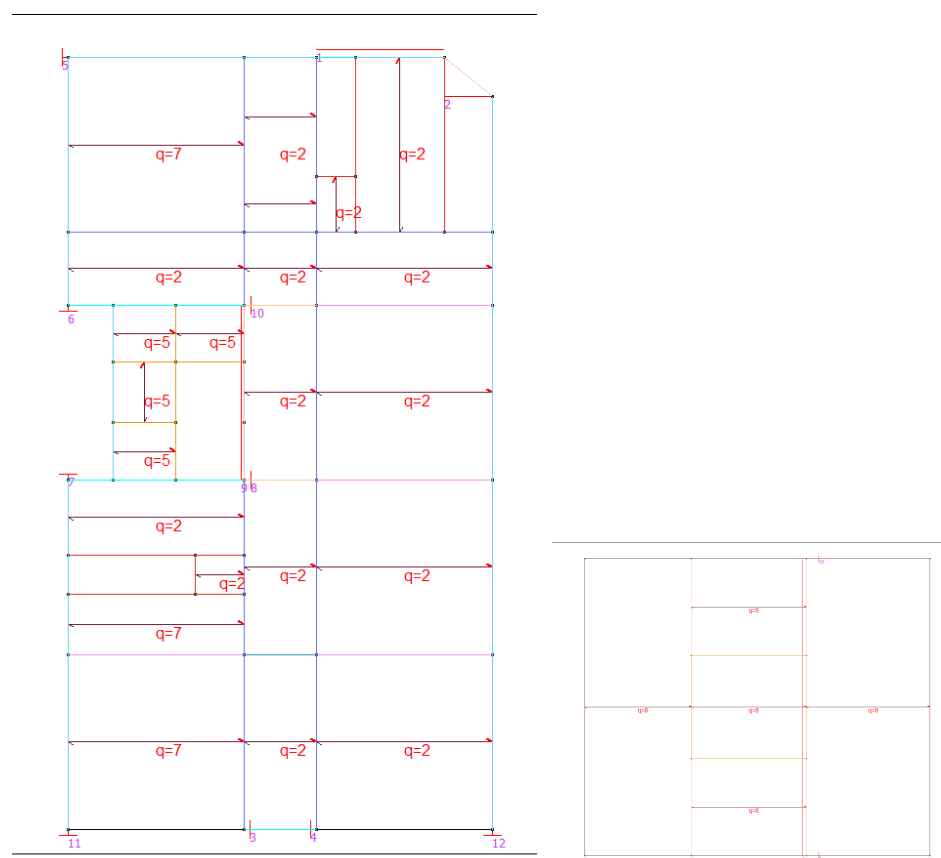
pianta solaio con indicazione tipologia solaio – pianta piano copertura e copertura torrino
